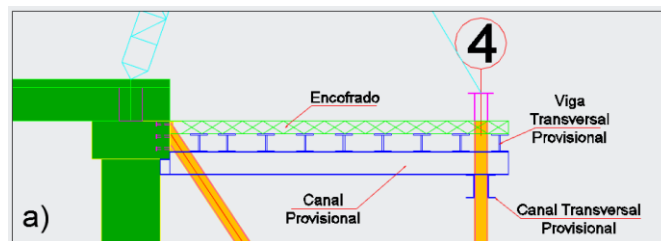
Montaje de encofrados móviles para el vaciado de la losa
